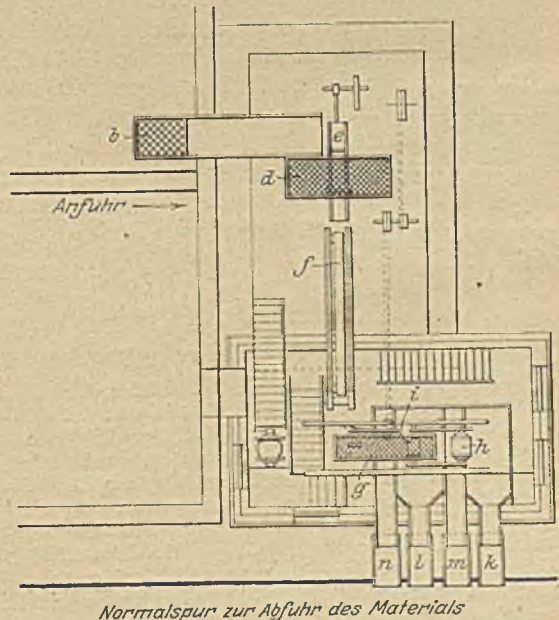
Grundriß der Eisenrückgewinnungsanlage.
